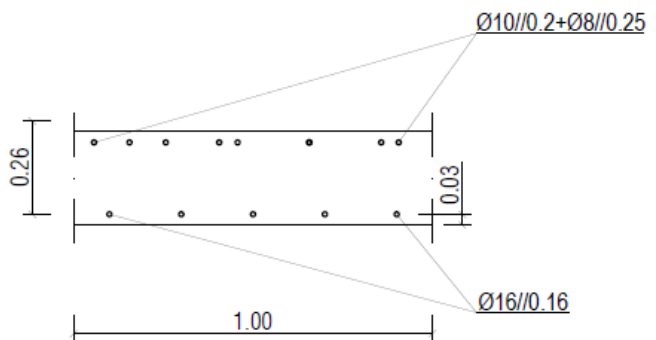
Secção transversal da zona de apoio para laje simplesmente apoiada
